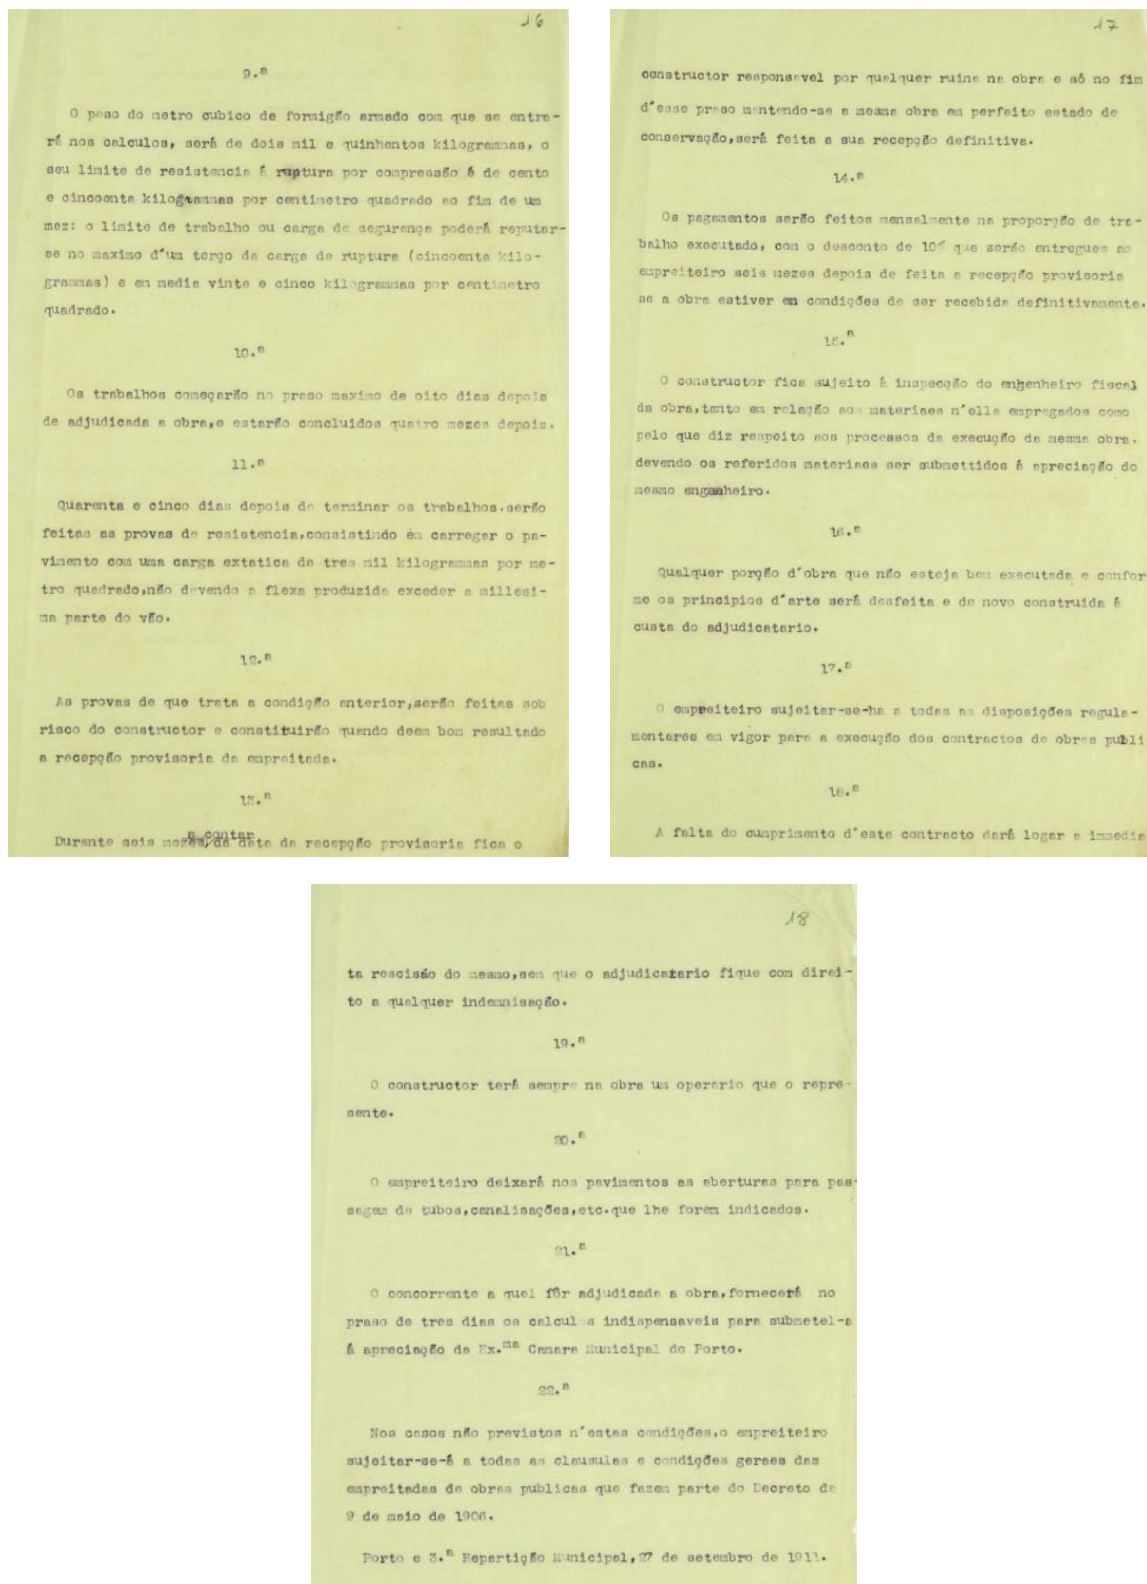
Condições de execução da “Variante ao projecto approved em 10 de Novembro de 1910. Substituição das abobadas em alvenaria por beton de cimento armado”.
